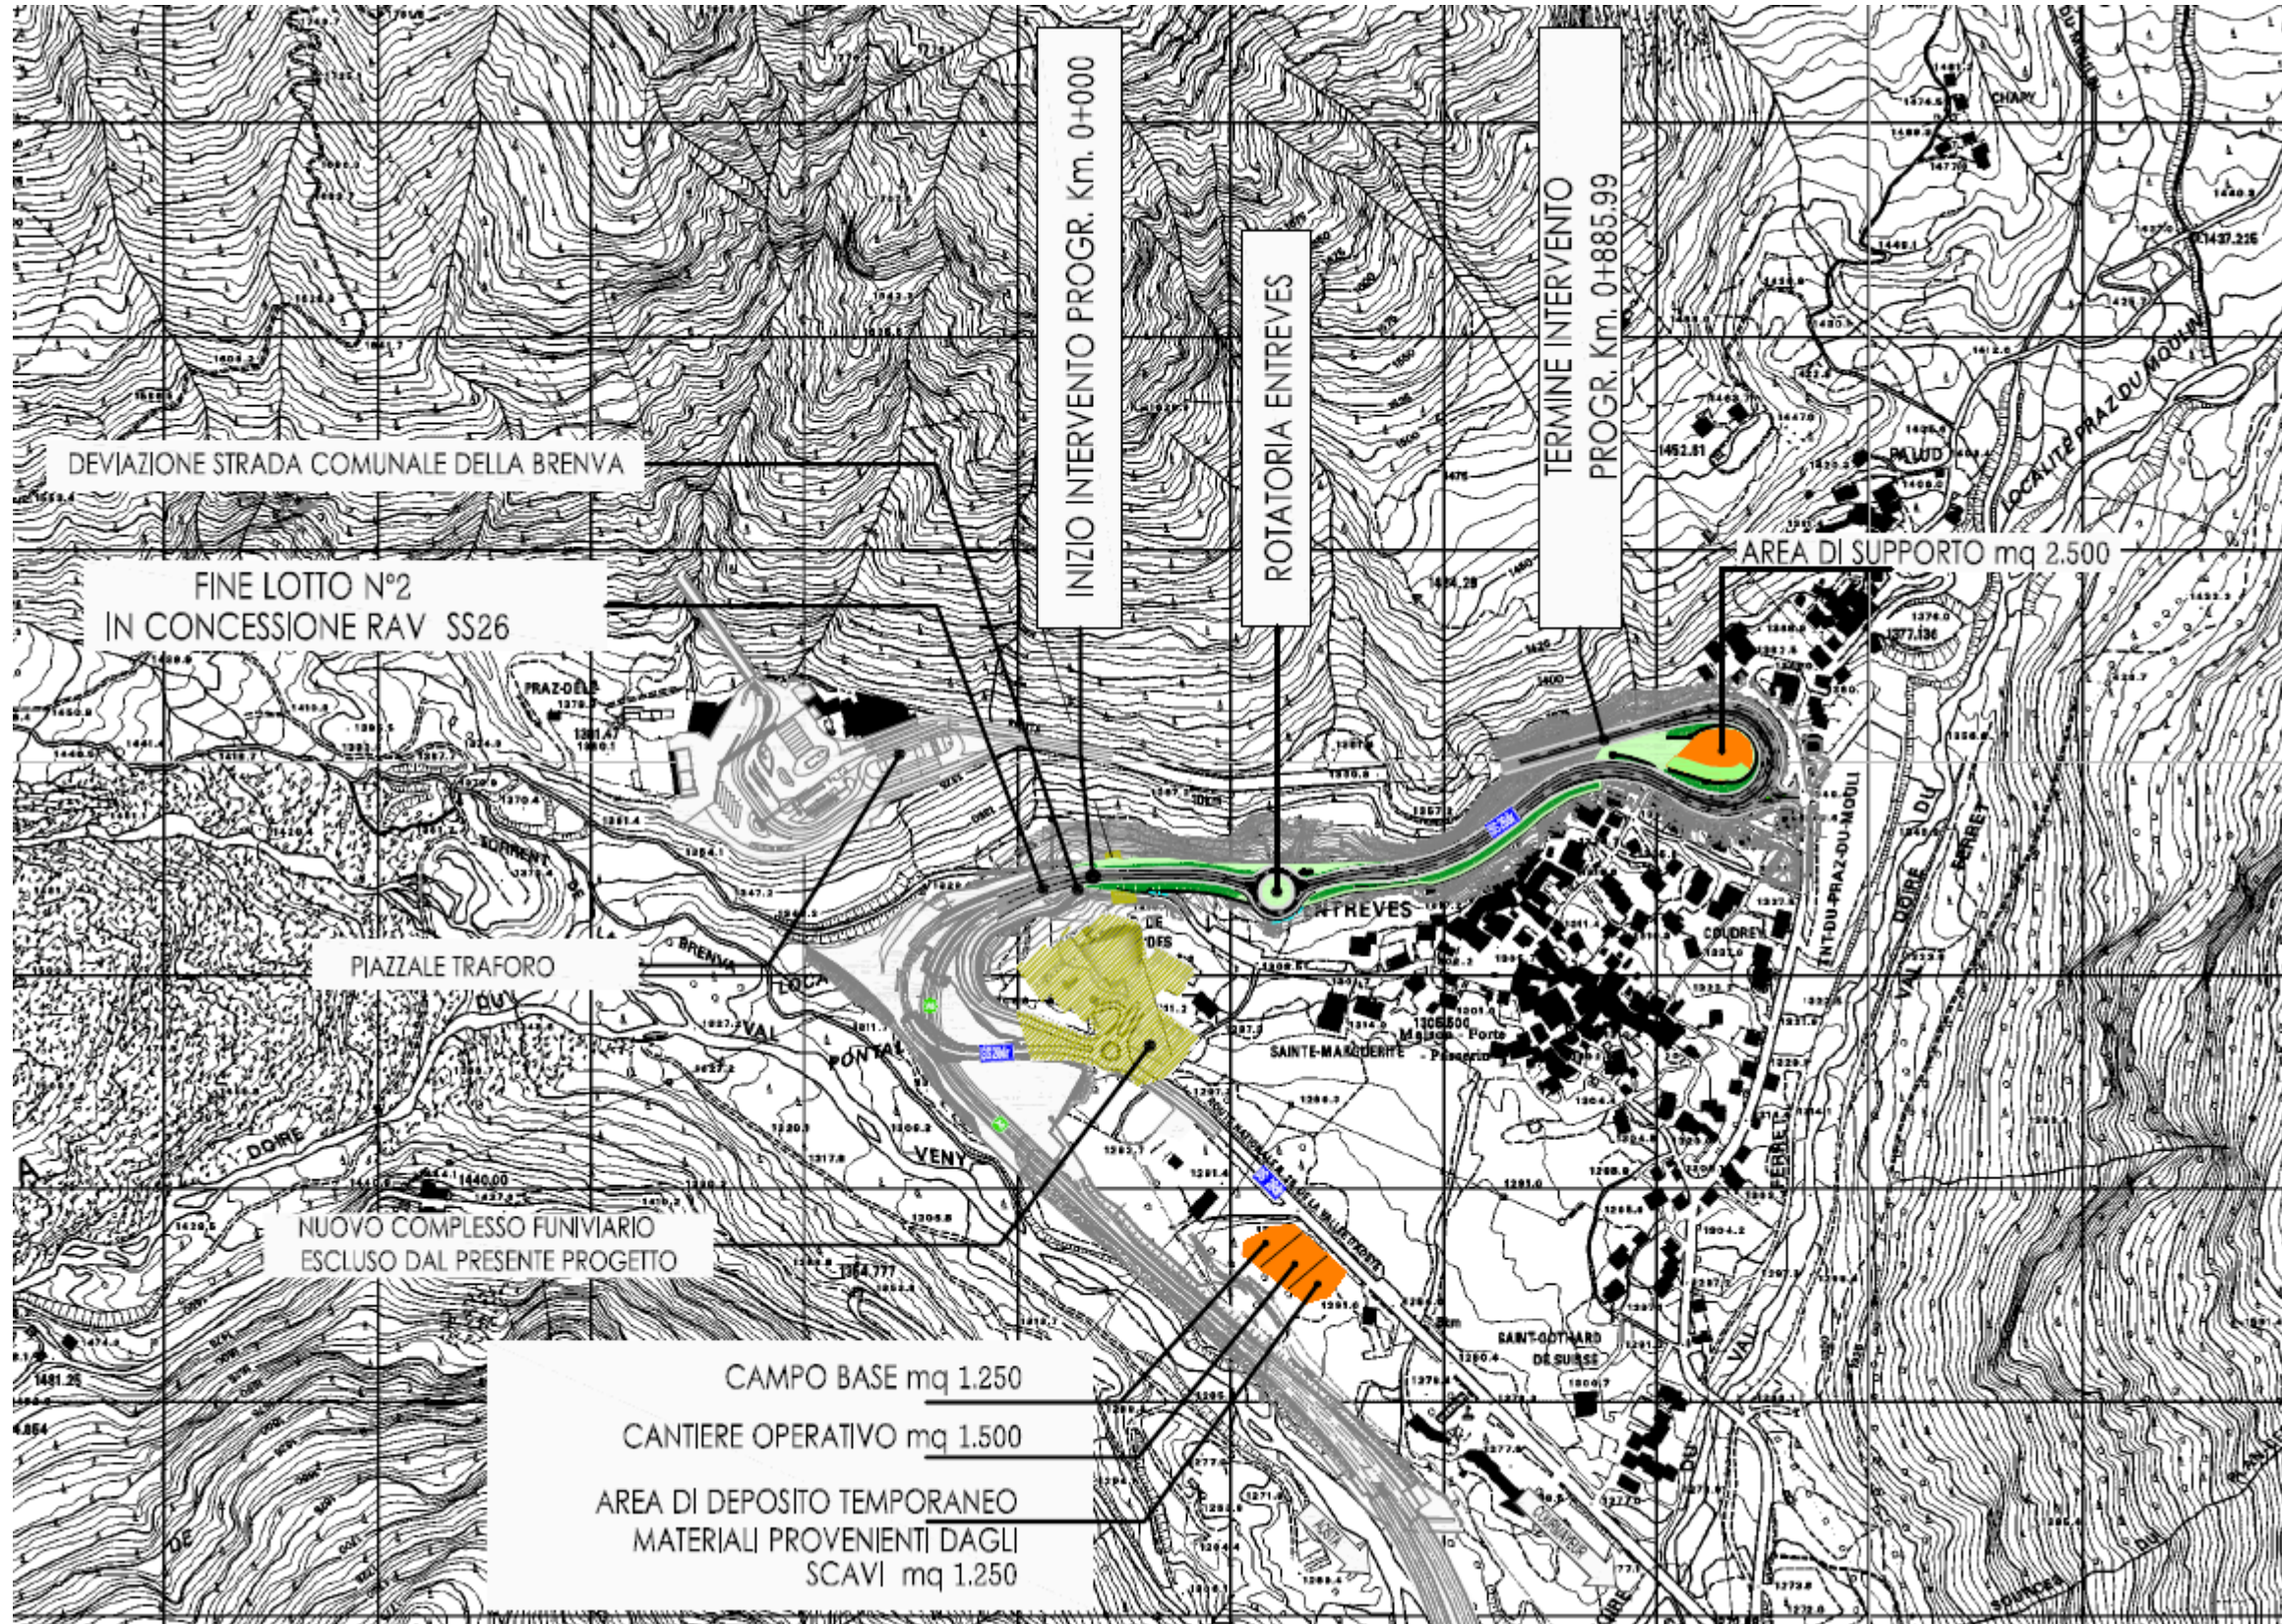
PLANIMETRIA DI PROGETTO
